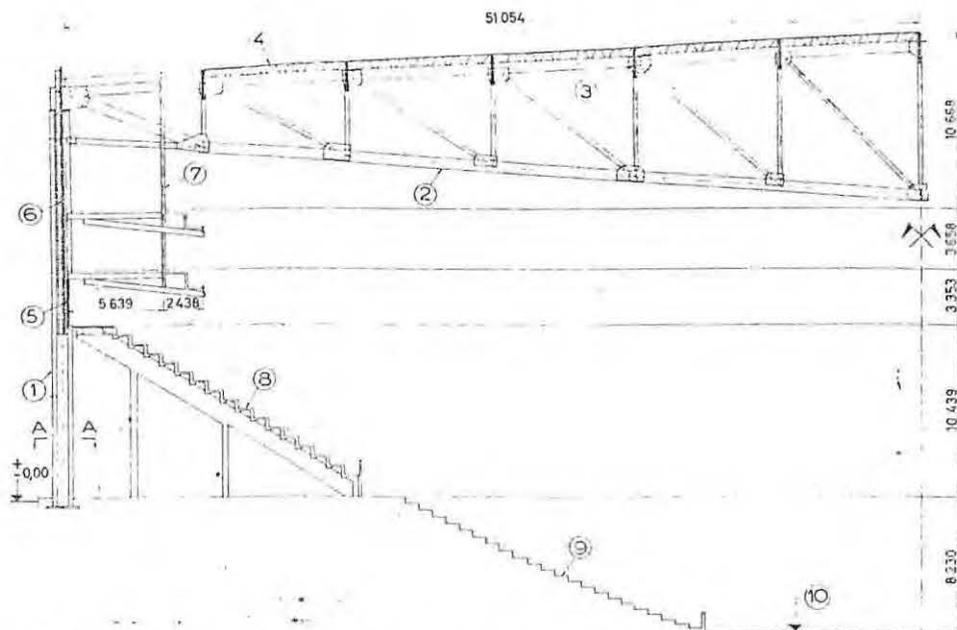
Semi sección transversal en el edificio. (1) Columna metálica principal. (2) Cercha principal. (3) Cercha secundaria. (4) Correas en celosía. (5) Viga en celosía en fachada. (6) Viga prefabricada en hormigón armado de sección en té. (7) Tirante de suspensión de los palcos. (8) Gradas prefabricadas de hormigón. (9) Gradas hormigonadas in situ. (10) Pista.
